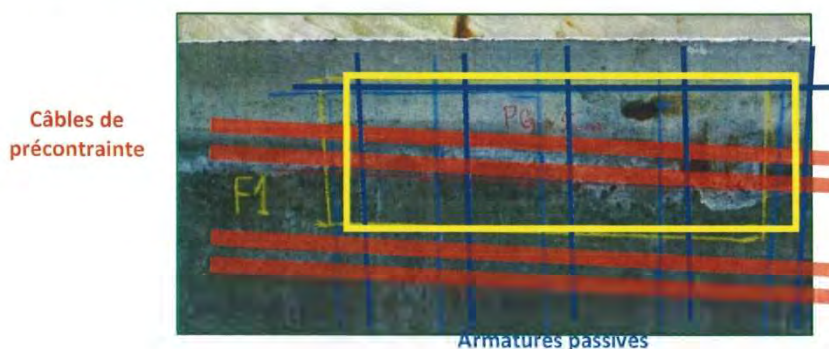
Exemple d'implantation d'une fenêtre en sous face de poutre d'un VIPP
